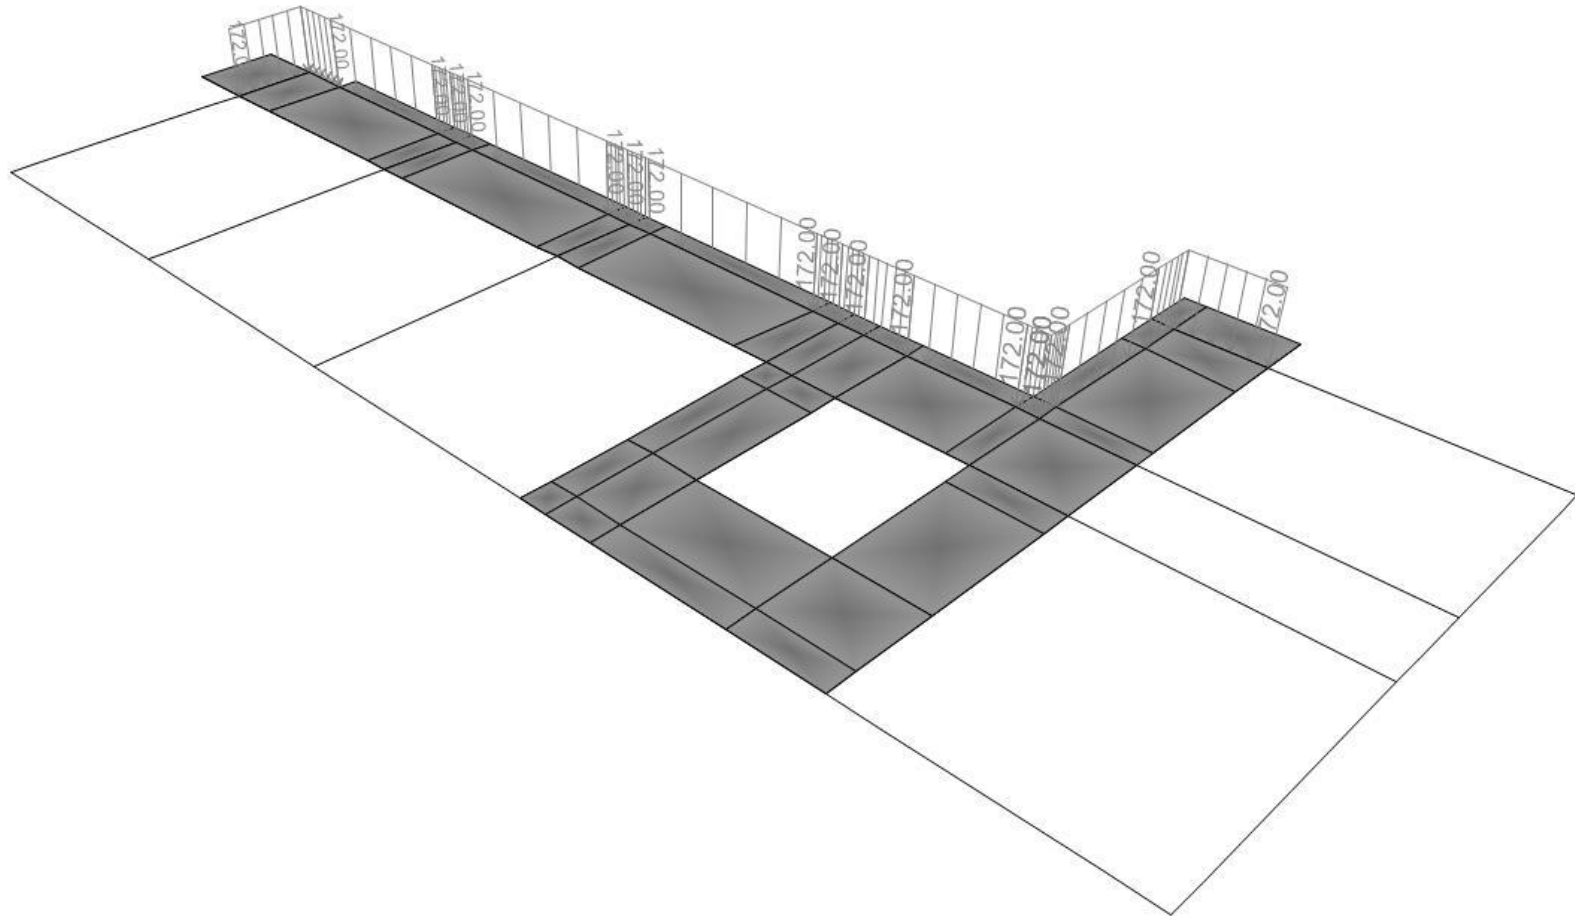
Carga muerta sobre vigas de cubierta N+9.00m
